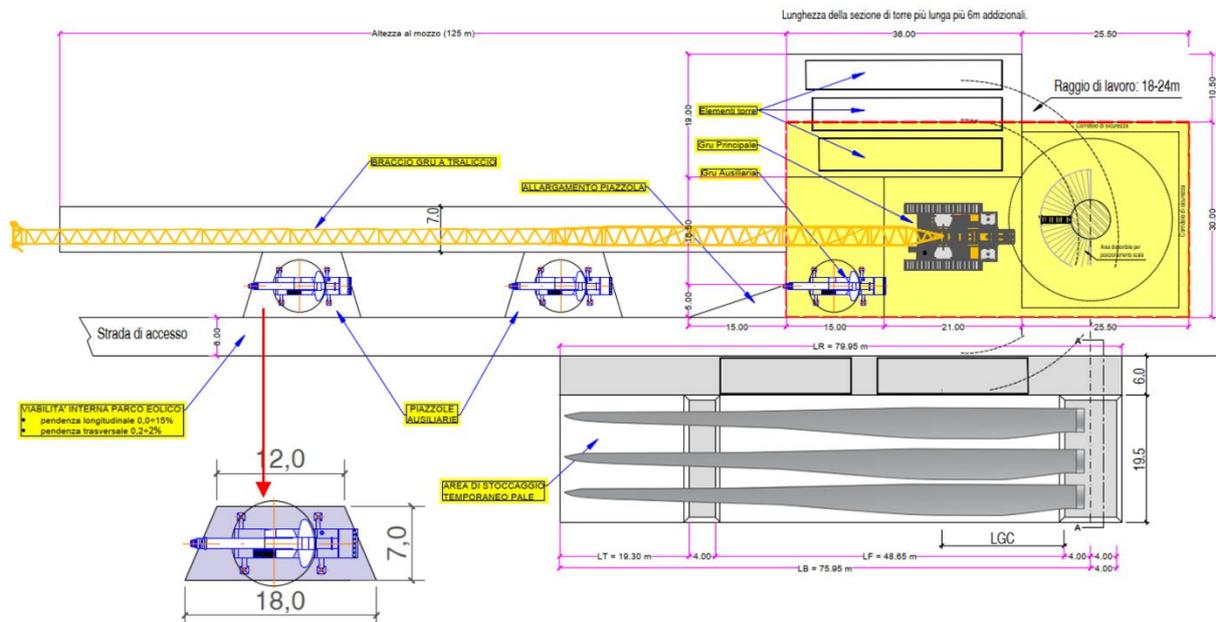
Stralcio Elaborato di Progetto “NIR.ELB05a” Piazzola tipo aerogeneratore - Planimetria
